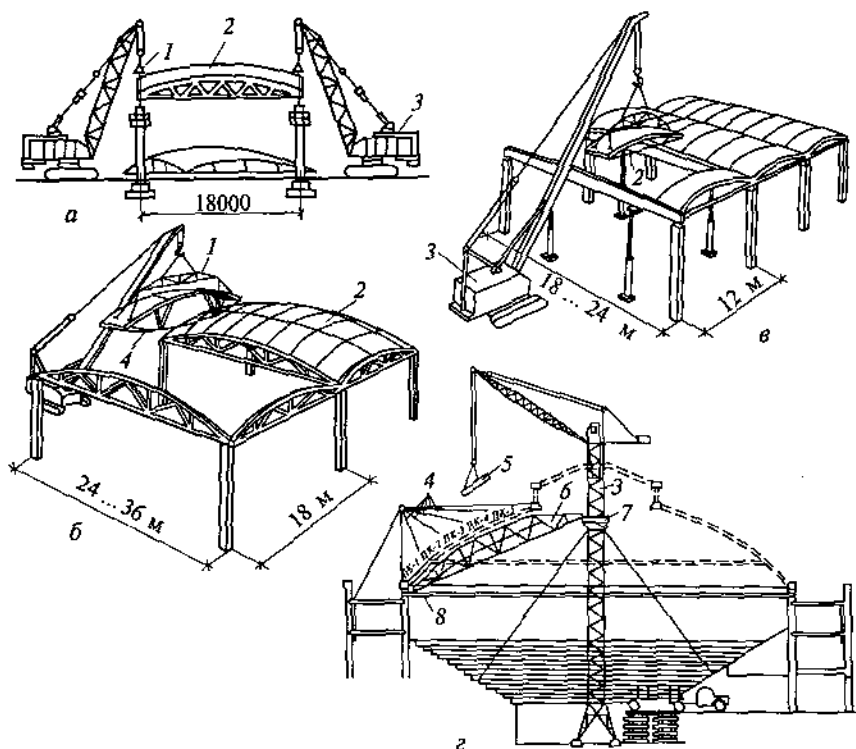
Схема монтажа железобетонных оболочек и куполов:
